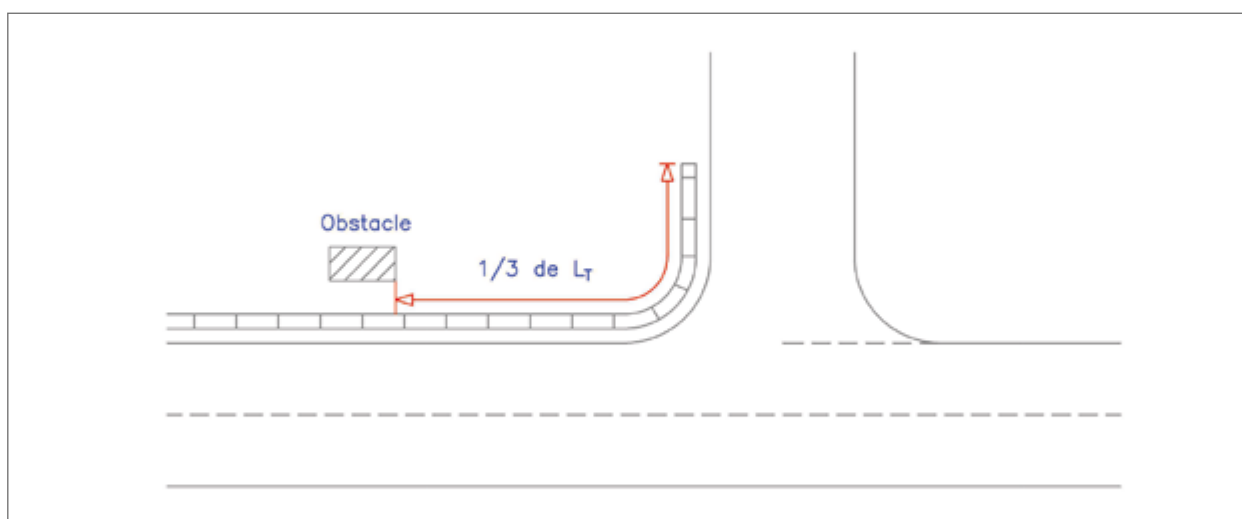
Traitement d'un obstacle à proximité d'un carrefour plan (Source : Cerema)
